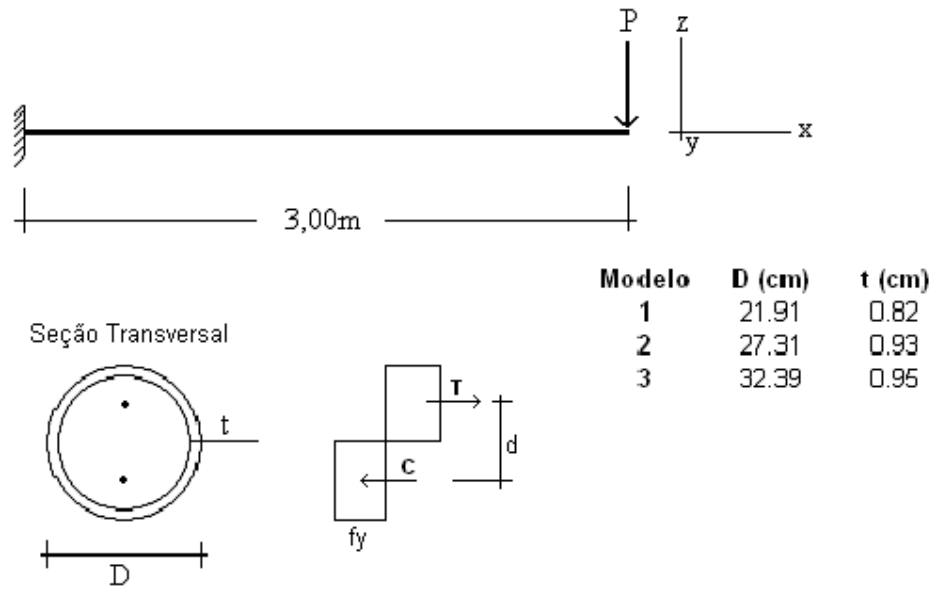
Esquema Estrutural da Viga em Balanço
